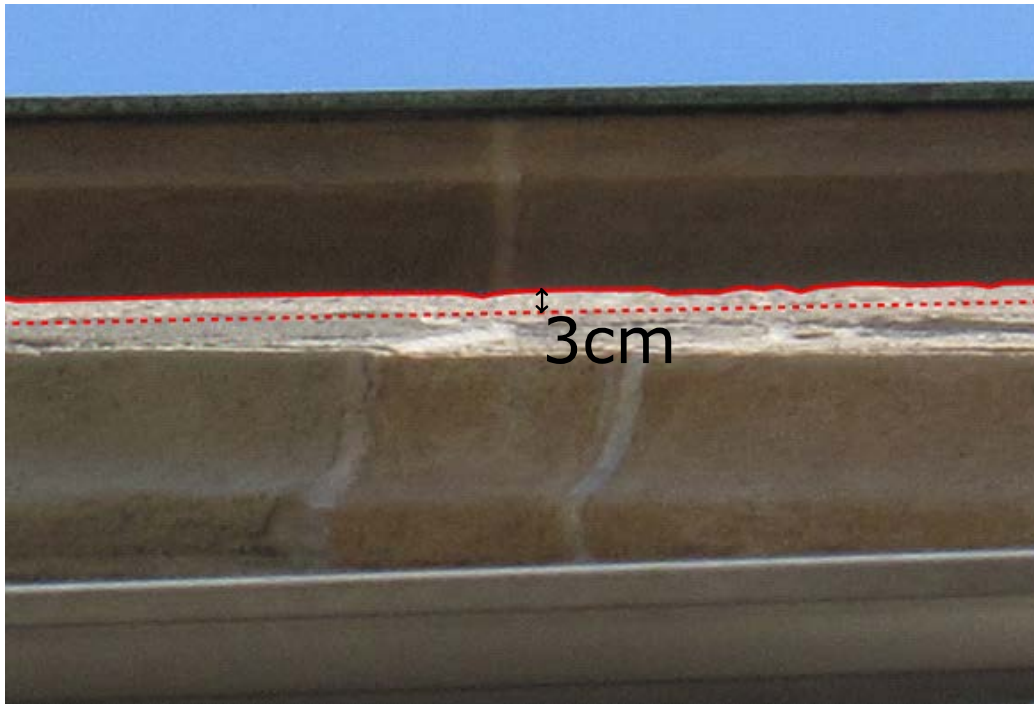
Chur, Westfassade der Kathedrale. Vergrößertes Detail der oberen Fensterlaibung des großen Fensters in der Kathedrale Chur, Westfassade. Die konkave Wölbung, welche erst durch die Gesamtbetrachtung der Fassadenbreite ersichtlich wird, wurde hier durch den Zwischenraum von durchgehender und strichlierter Linie verdeutlicht, wobei letztere sich durch die NW- und SW-Ecken vorgegebene Mauerflucht orientiert. Foto: Stefan Fiechtner, Innsbruck.
